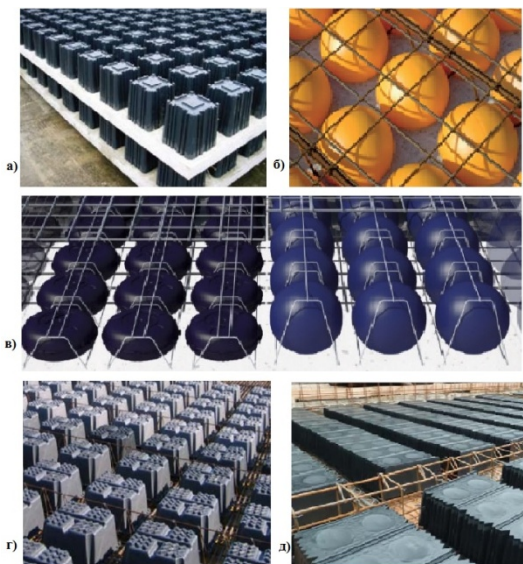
Системы с применением полимерных вкладышей: а) Airdeck, б) BubbleDeck, в) Cobiax, г) U-Boot Beton, д) U-Bahn Beton
